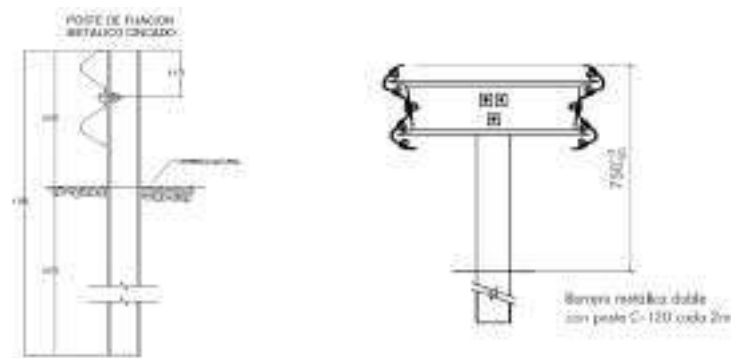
detalles de barreras metálica de protección. Fuente: Elaboración propia.
